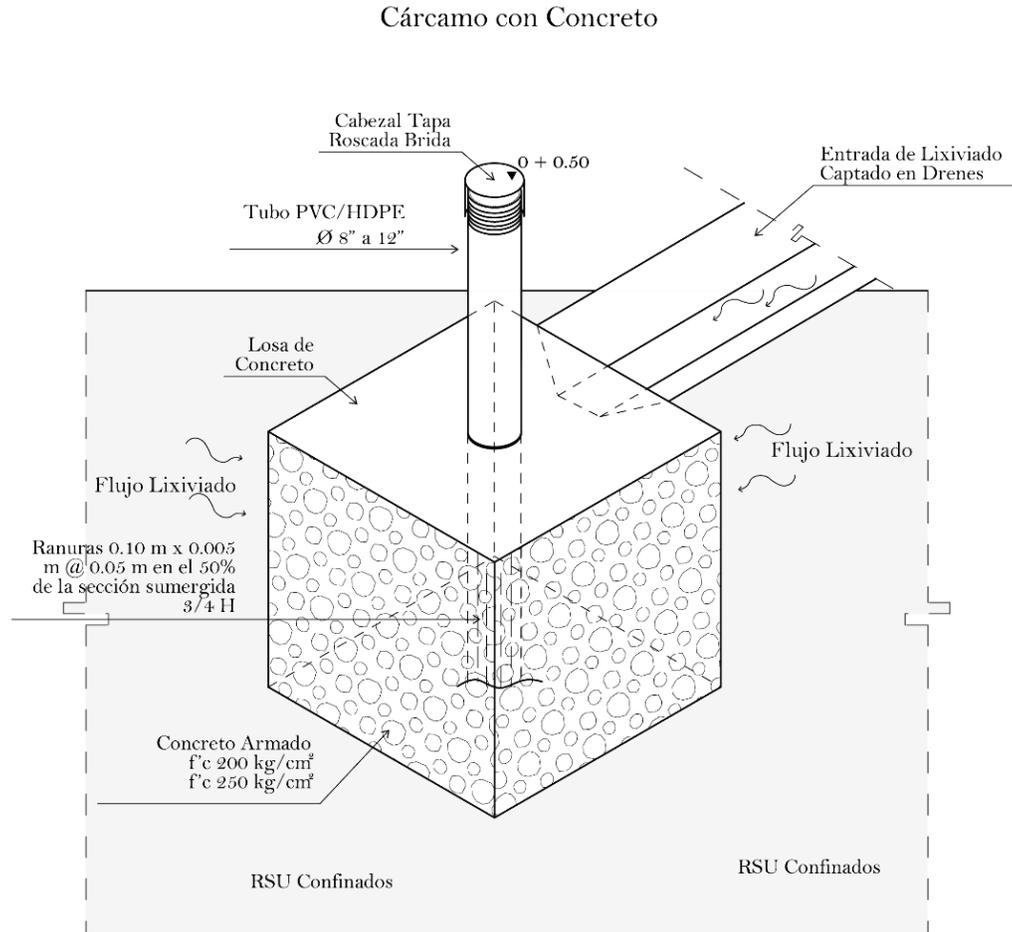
Diagrama de cárcamo de concreto armado para la captación de lixiviado
